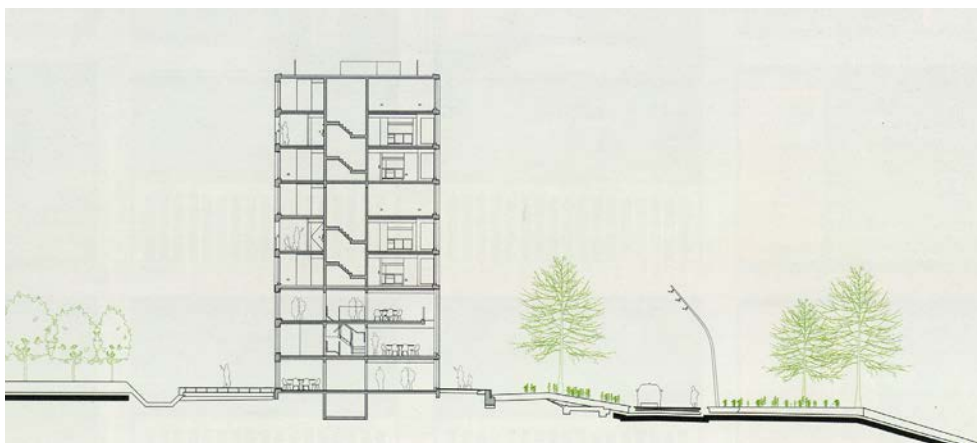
Sección transversal por un de los bloques. En The Plan 2012.
